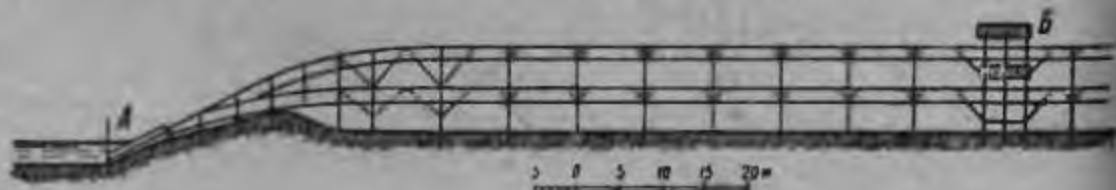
Продольная лесотаска на эстакаде на берегу от воды до завода.
